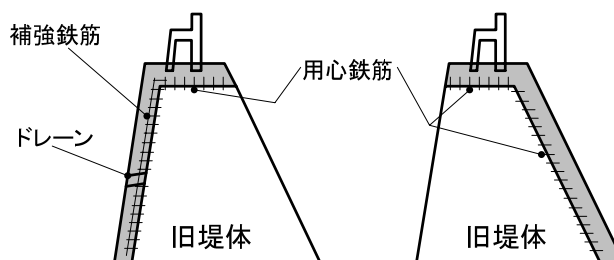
新旧コンクリートおよびコンクリート・鋼材部の一体化
